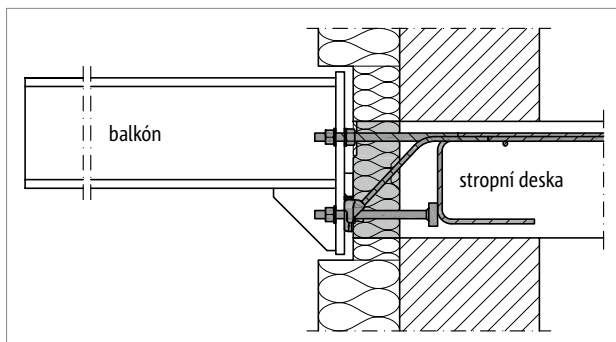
Schöck Isokorb® T typ SKP: Volně vyložený balkón
